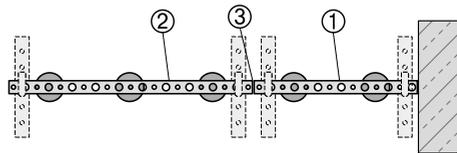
Przykłady zestawów złożonych z elementów 2 lub 3 trzpieniowych
